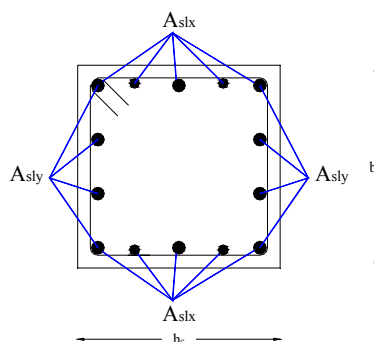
Configuração das armaduras longitudinais dos pilares.
